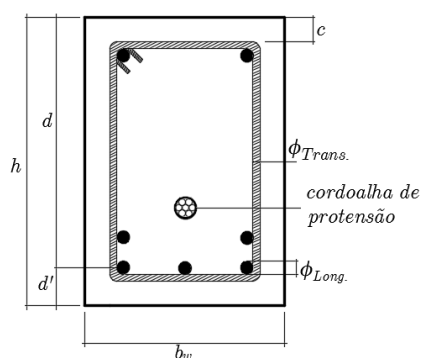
Seção Transversal de uma Viga Retangular de Concreto Protendido
